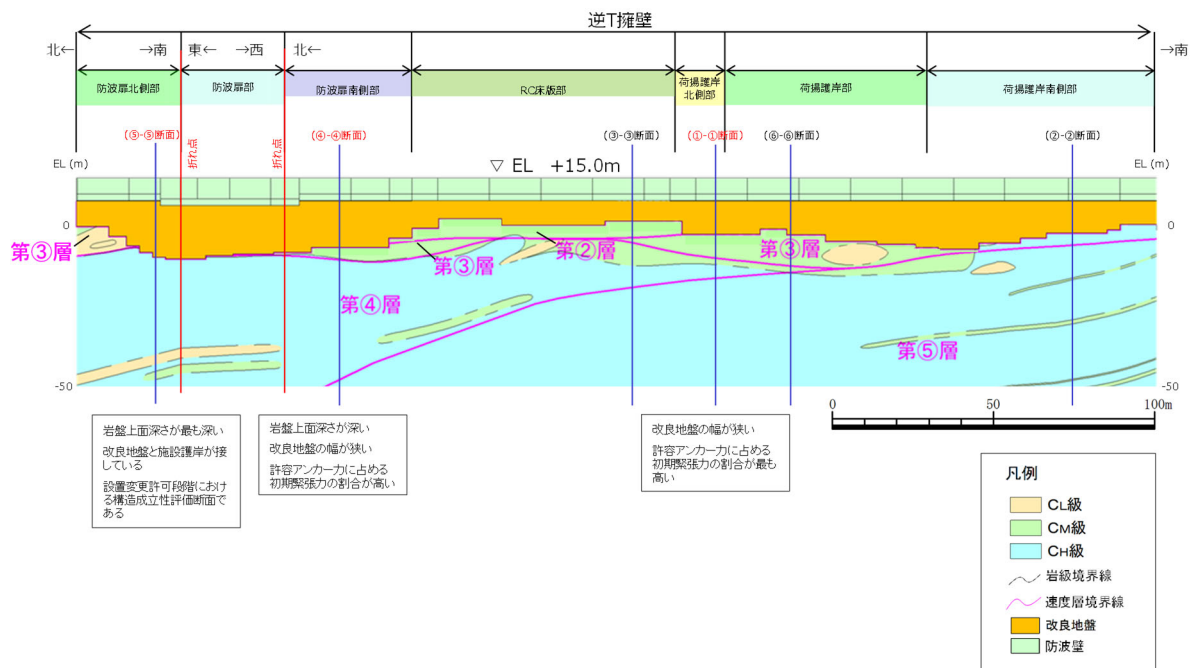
評価対象断面（横断方向）の縦断位置図
